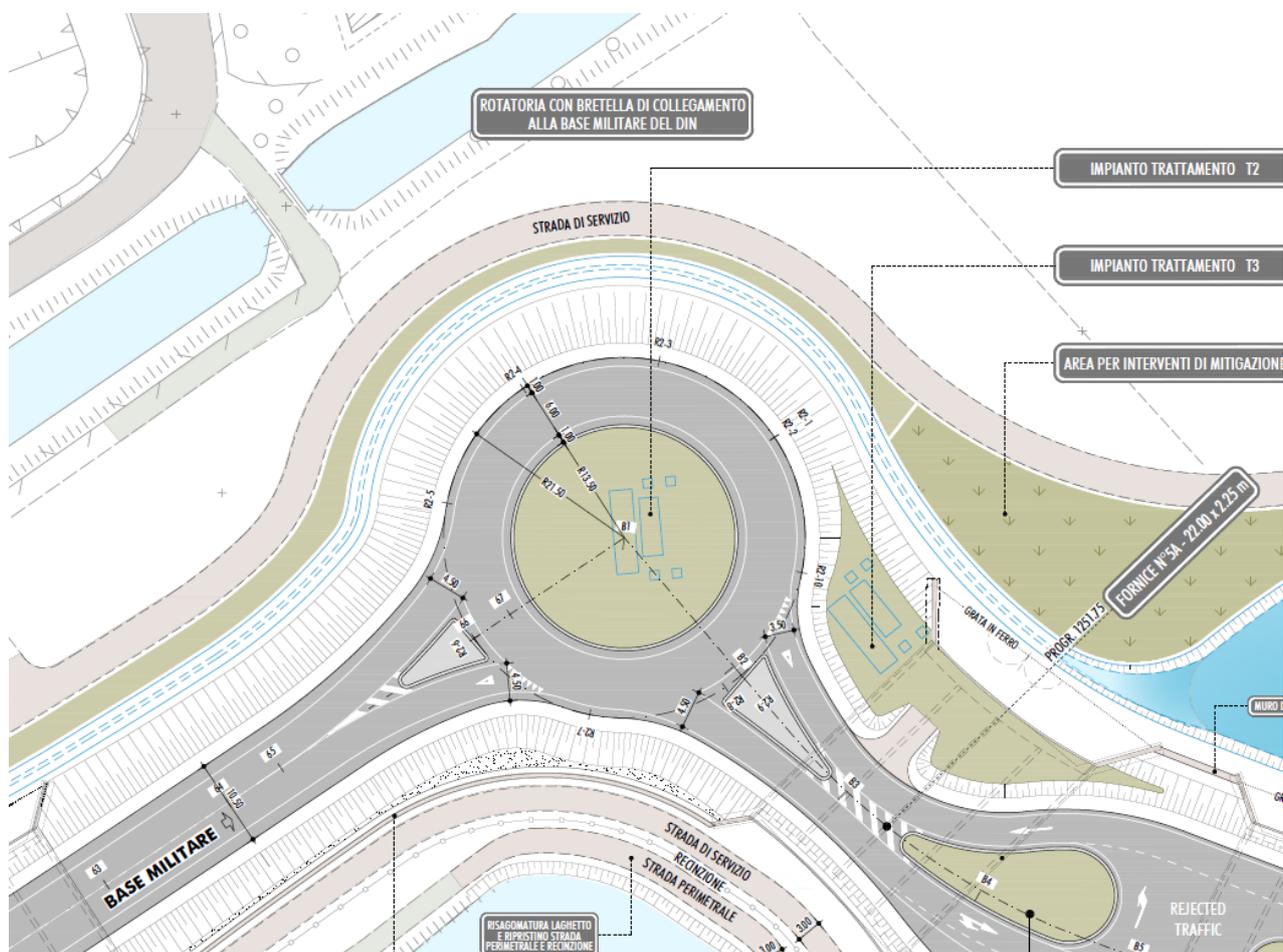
INTERSEZIONE A ROTATORIA DI COLLEGAMENTO ALLA BASE MILITARE "DEL DIN"
